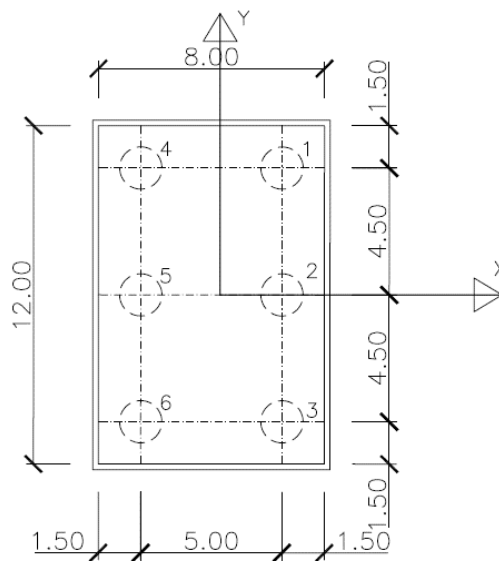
pianta a 6 pali – pile 5÷15 e pile 18÷30
